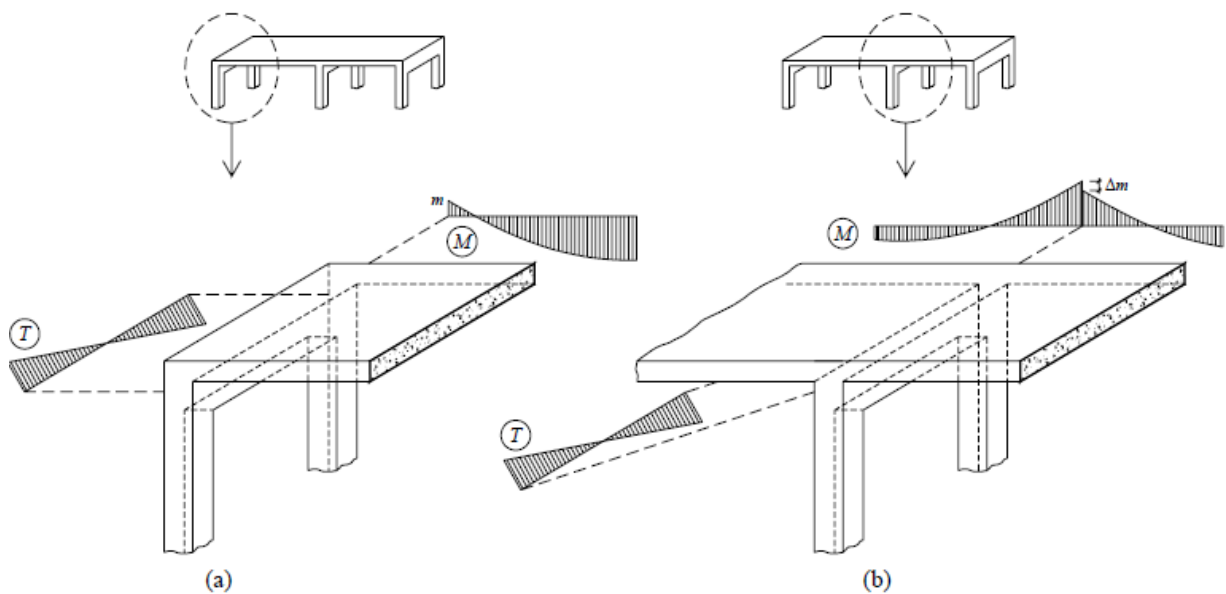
Apoio de laje de pavimento em viga de extremidade e de continuidade [16]
